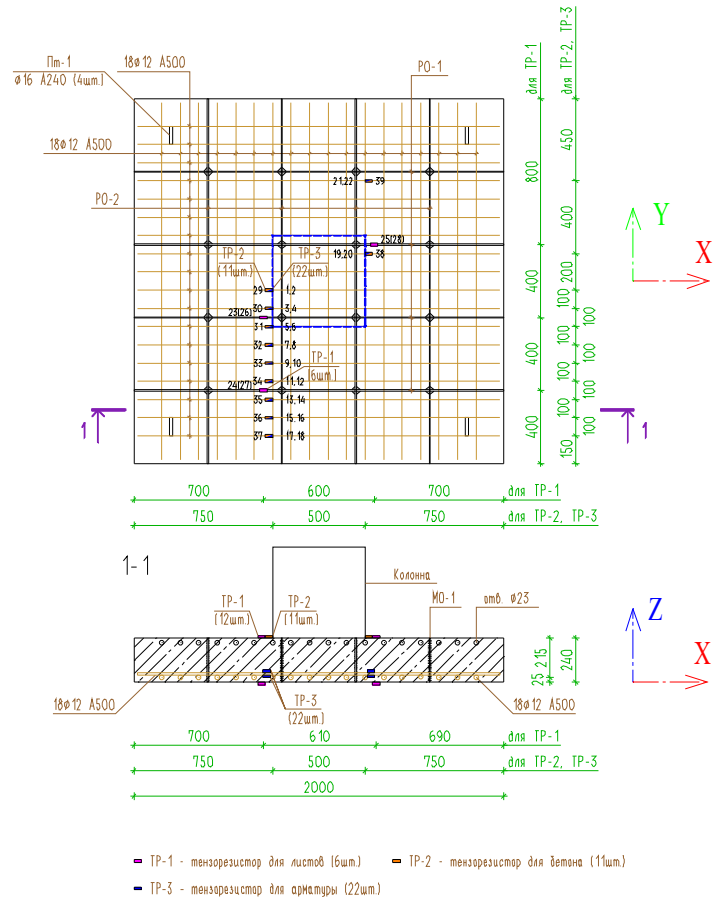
Фрагмент плиты перекрытия 3 (ФПП-3), РС63
